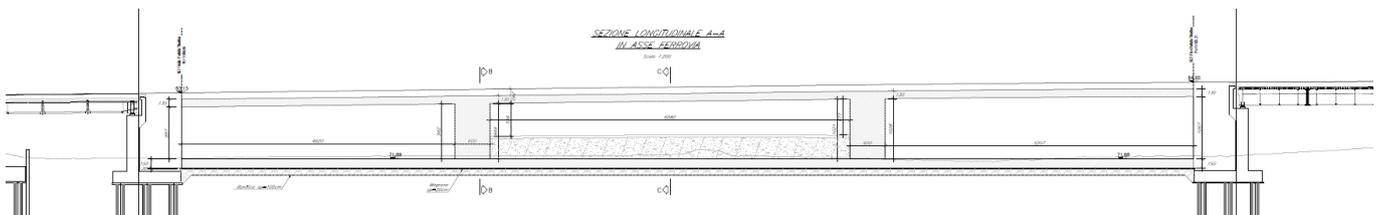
SL21 – Sezione longitudinale in asse ferrovia
